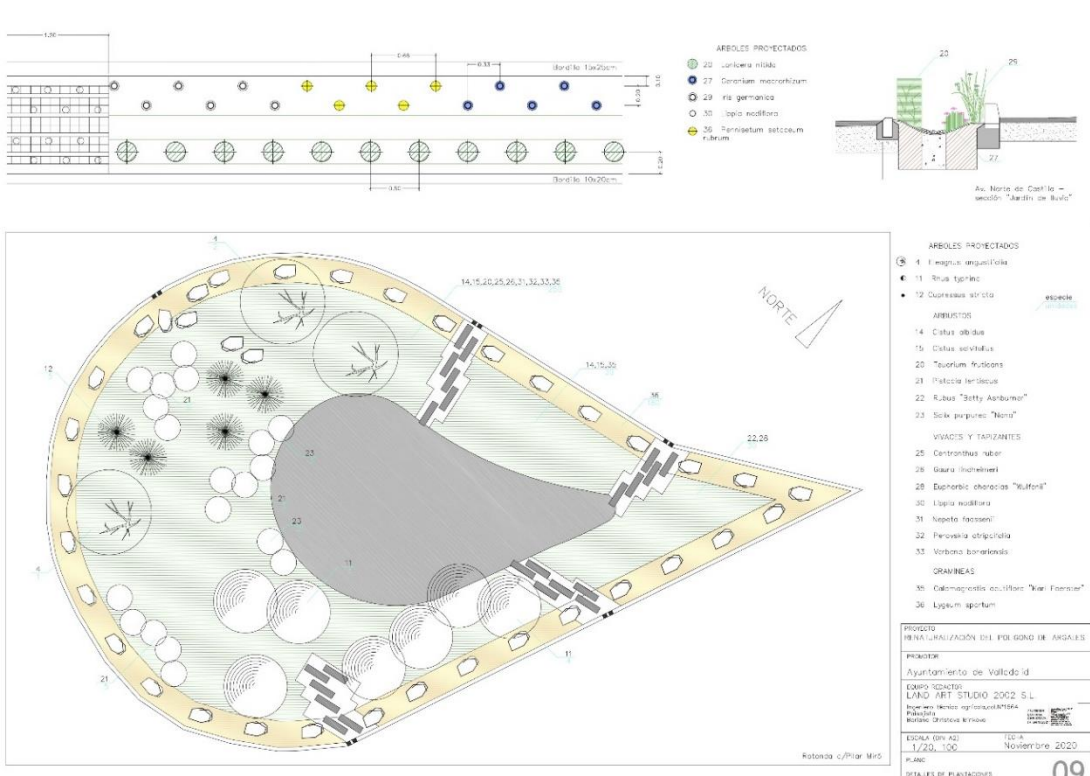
Detalle plantaciones de la rotonda Pilar Miró. Fuente: Land Art Studio 2000 S.L.
